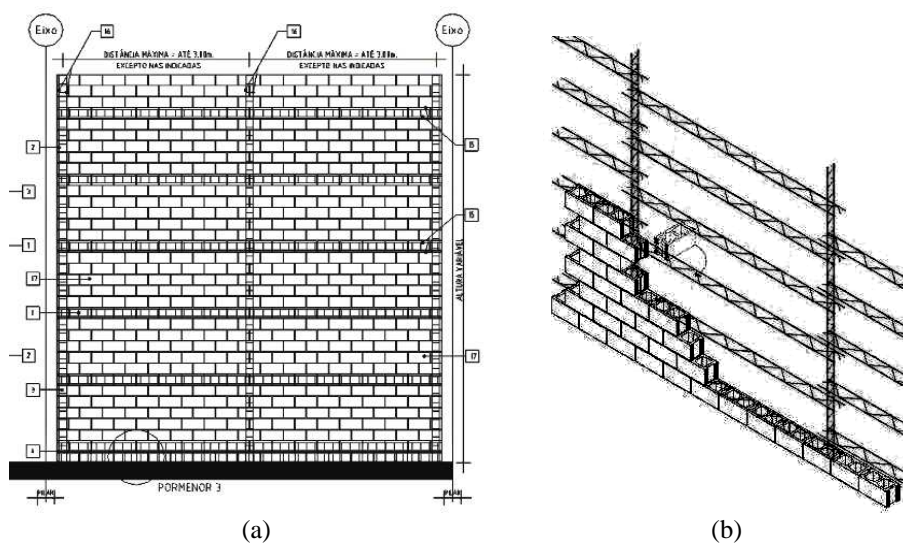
Alvenaria moderna armada (solução típica espanhola com Murfor®). Exemplos de: (a) parede de alvenaria não resistente com cintas e montantes em betão armado; (b) parede não resistente alternativa com sistema de armaduras verticais e horizontais em treliça.
